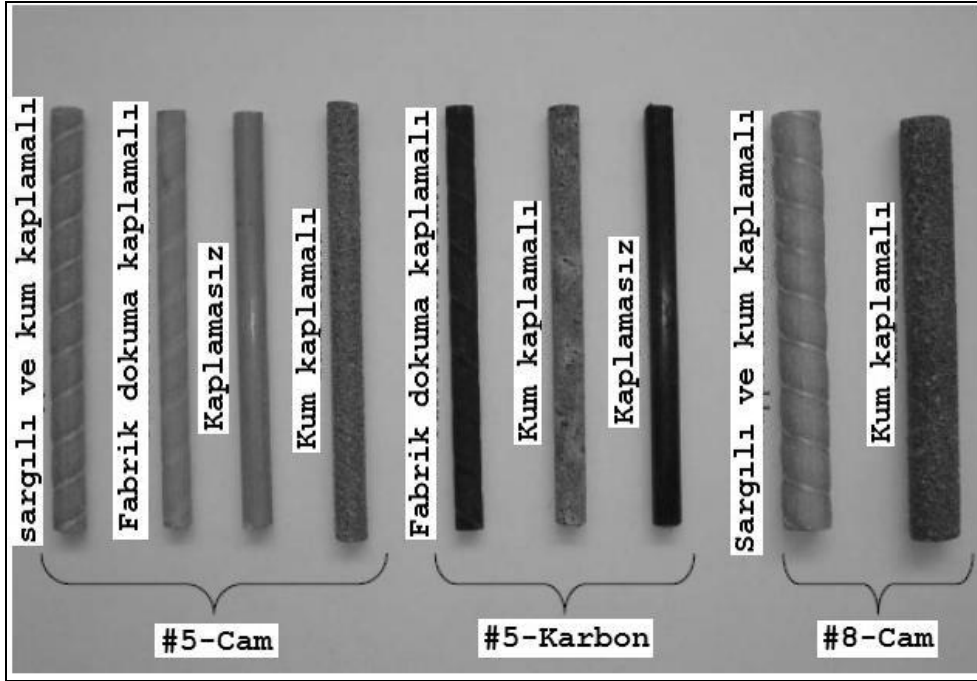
Betonarme yapılarda iç ve dış donatı olarak kullanılan FRP tipleri[1]
